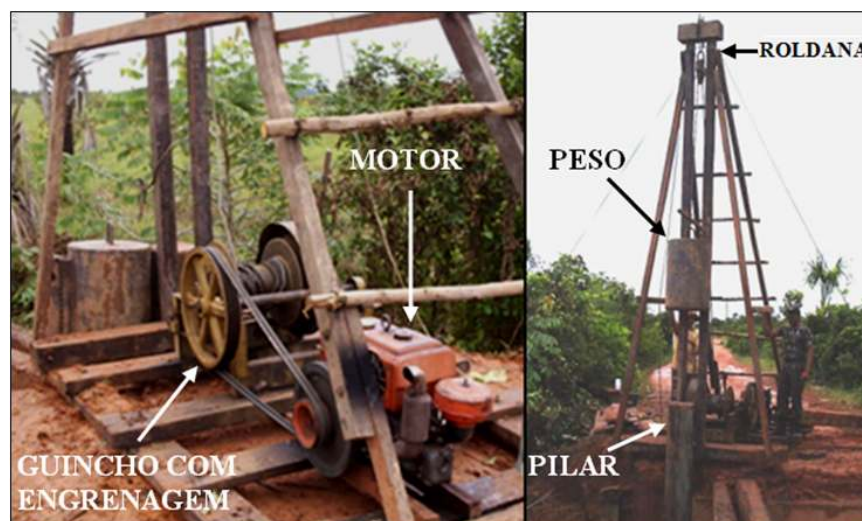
Detalhes de um BATE-ESTACAS portátil montado no encontro de uma ponte
